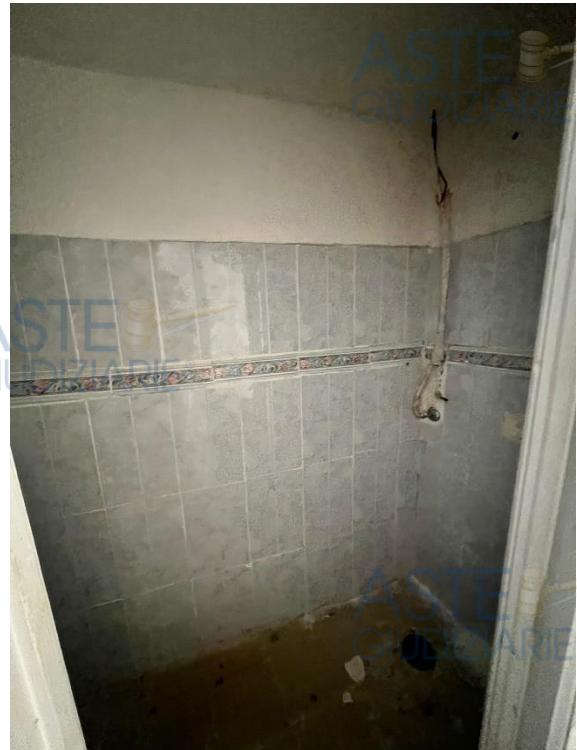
Vista degli interni dell’Abitazione con particolare riferimento all’ambiente W.C..
